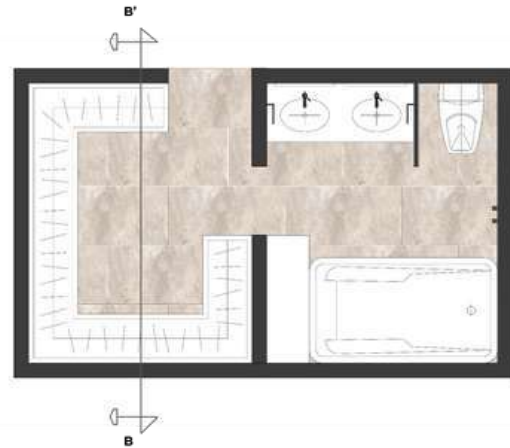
Planta de baño con texturas, señalamiento de corte. Fuente: Autoría propia.
